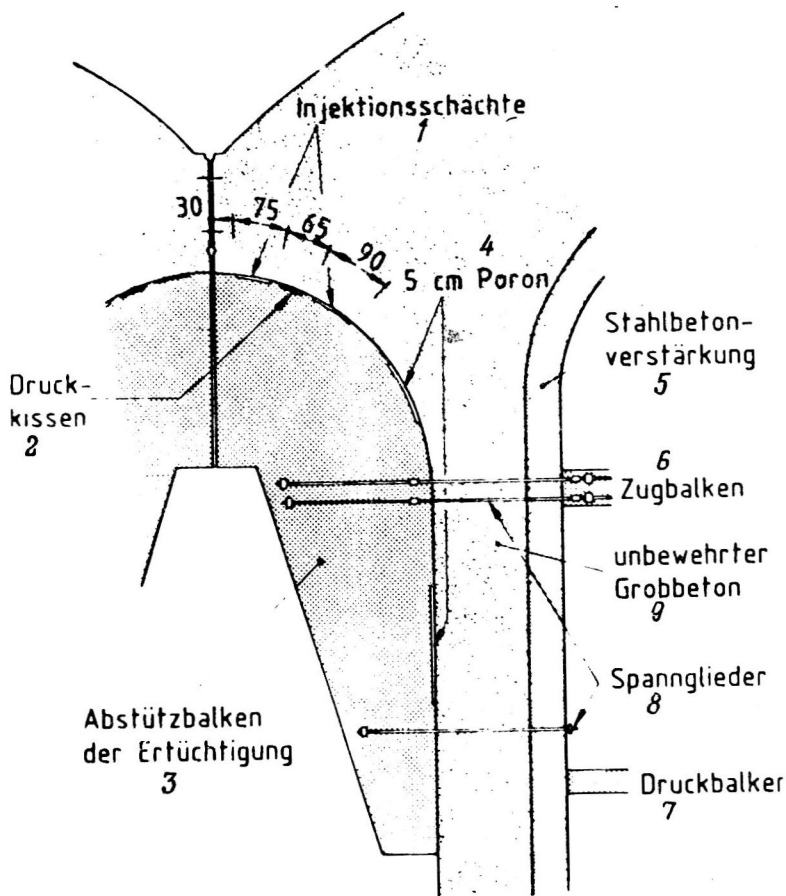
Конструкция контактного шва между консолью оголовка и поддерживающей ее конструкцией. План:
